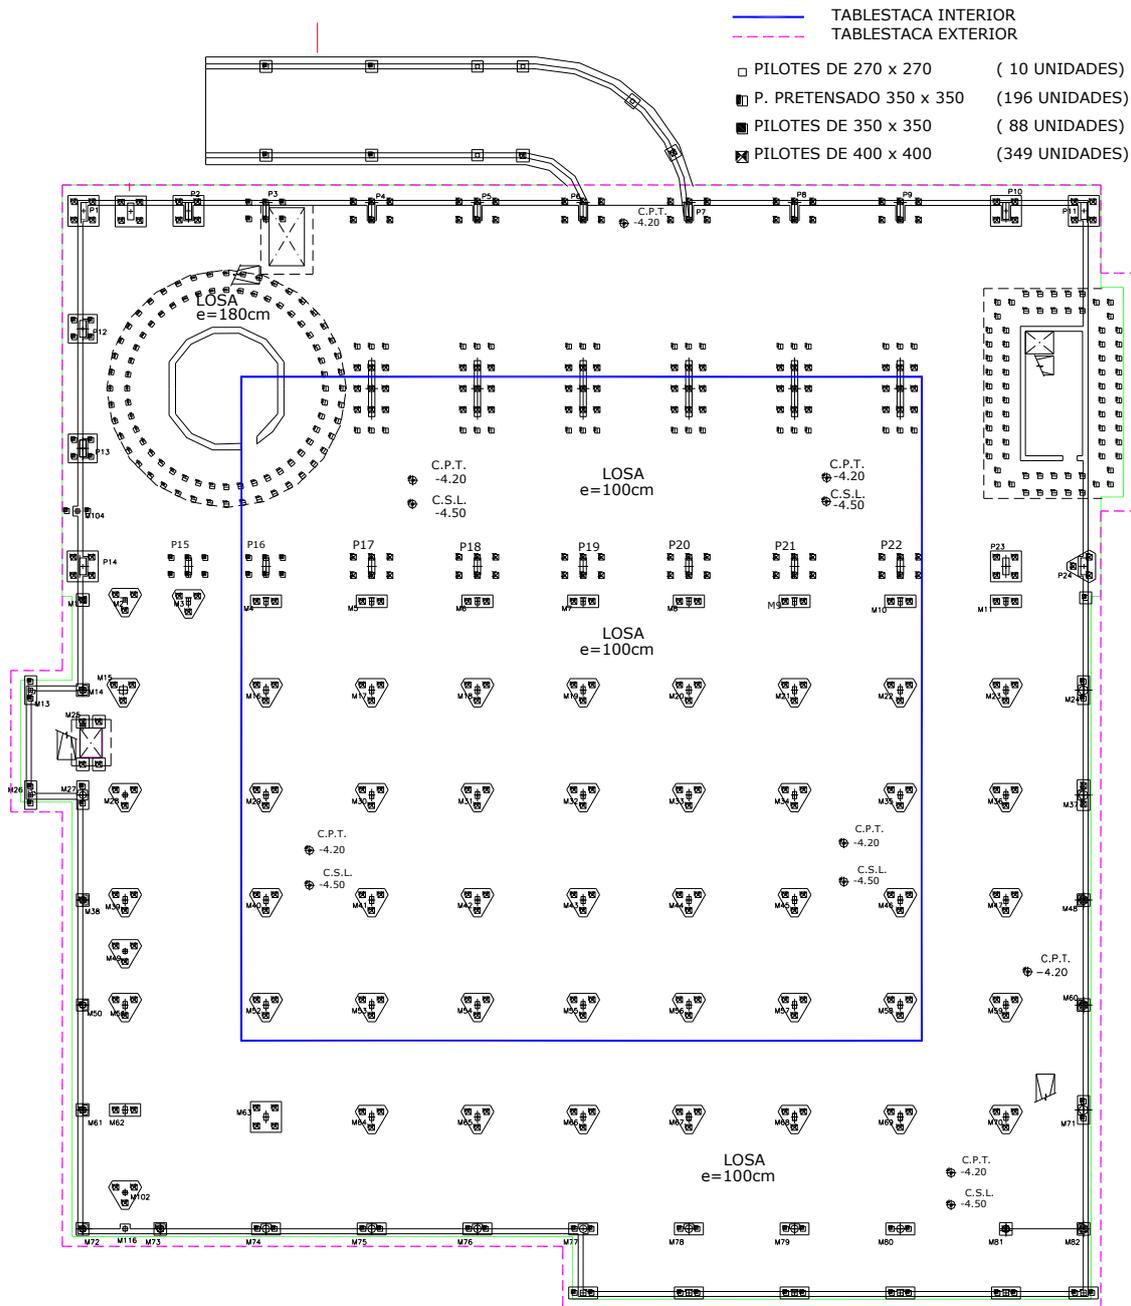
Situación de pilotes y encepados. Cantos de losa de cimentación.
